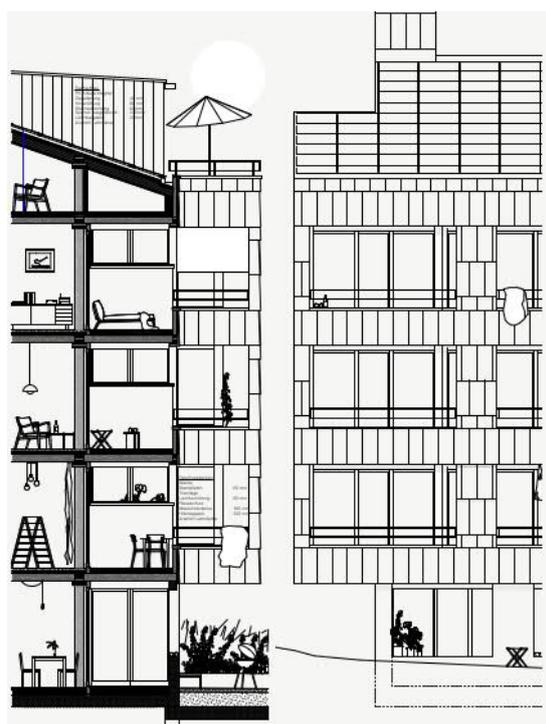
Fassadenschnitt Abusitz (massstabslos)
